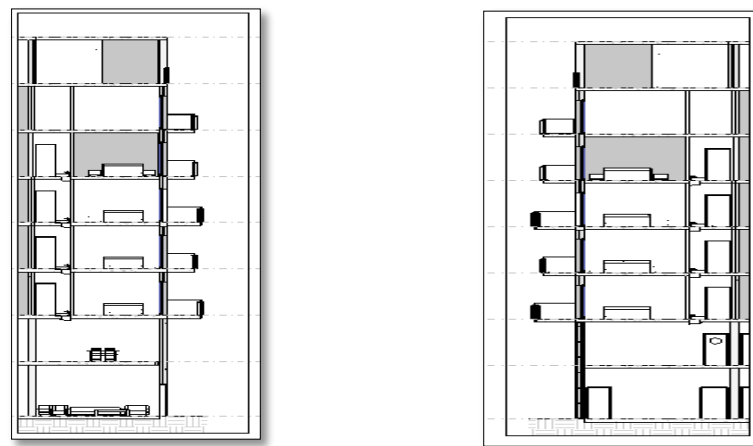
Photo : à droite, coupe 1 ; à gauche, coupe 2,
